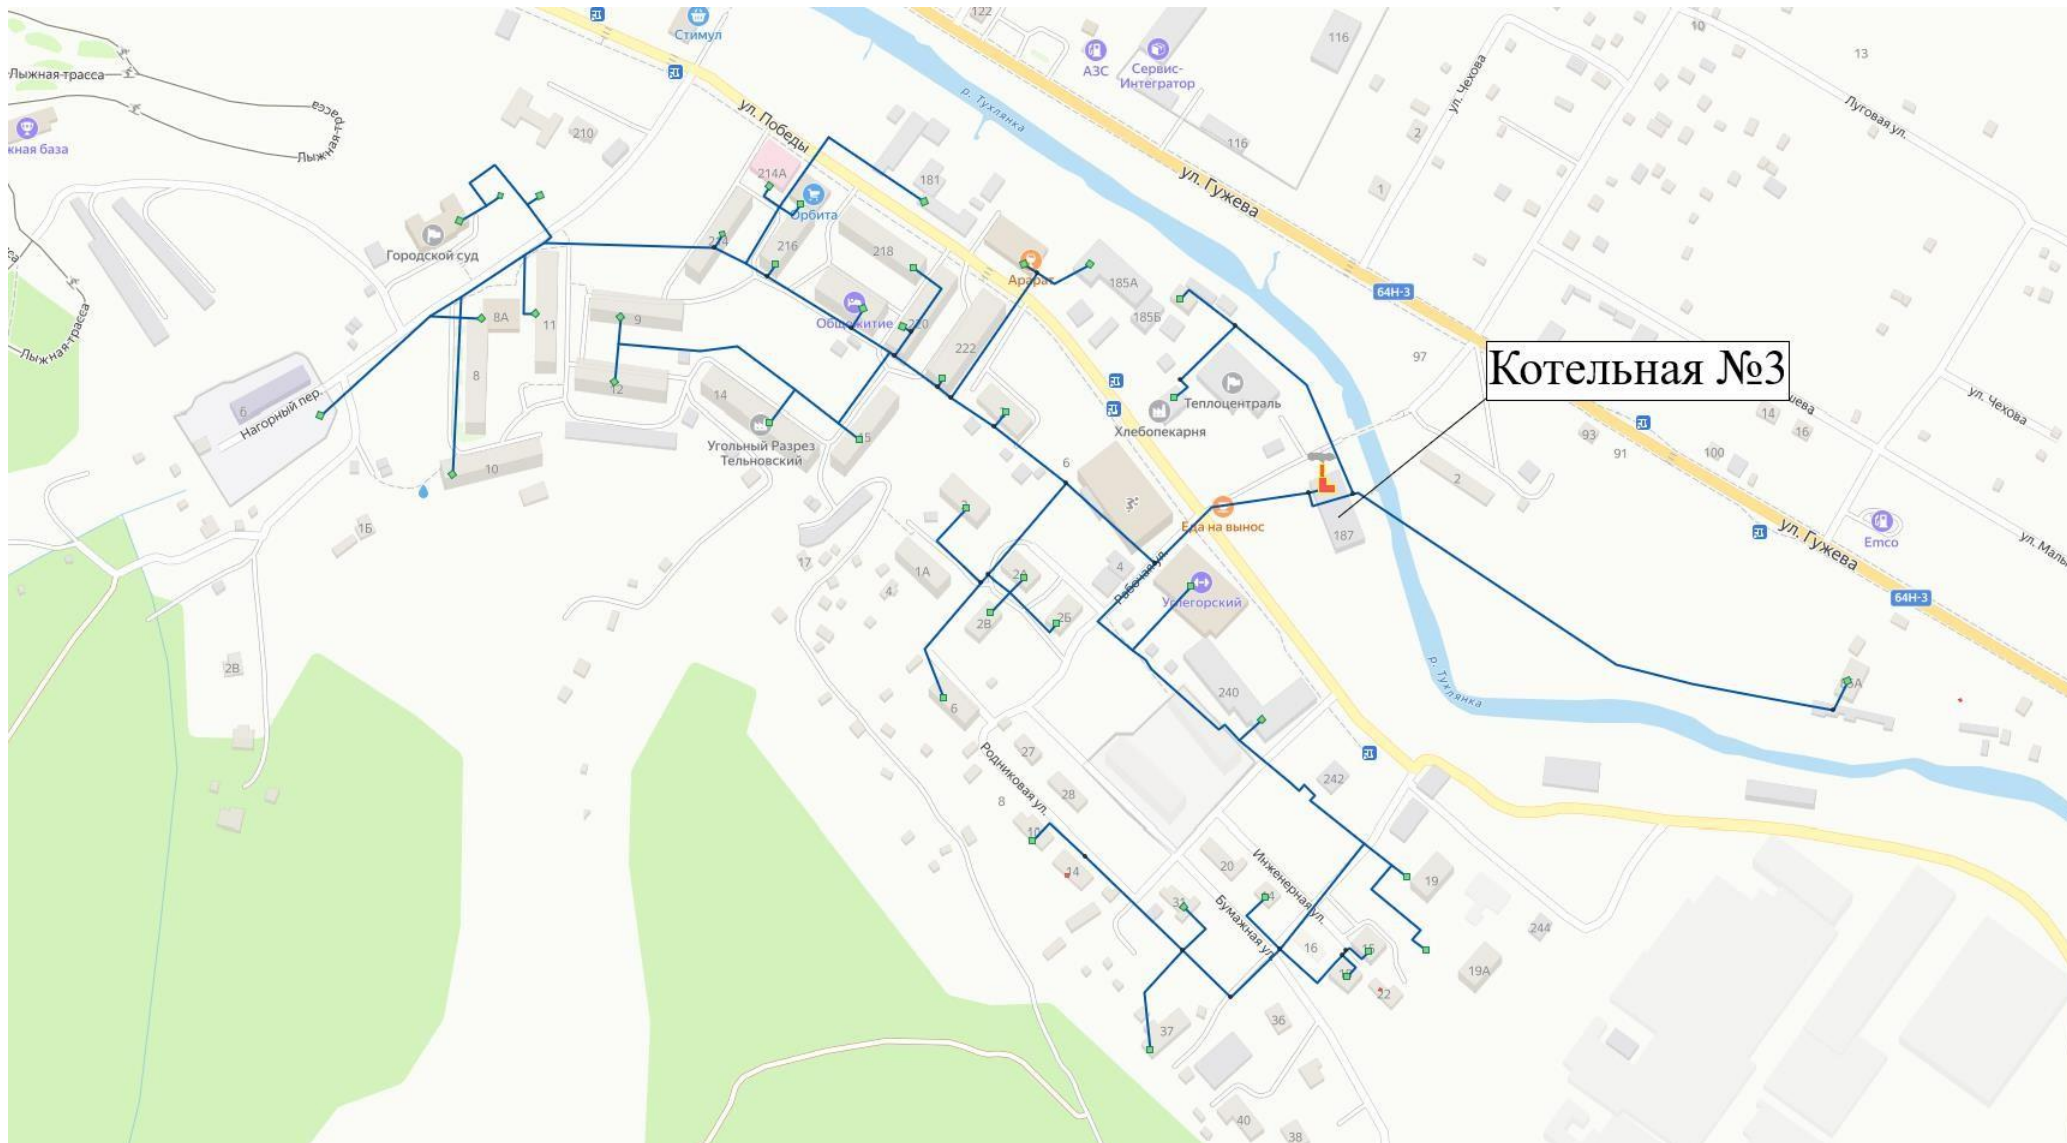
Схема тепловых сетей котельной №3 г. Угледорск
